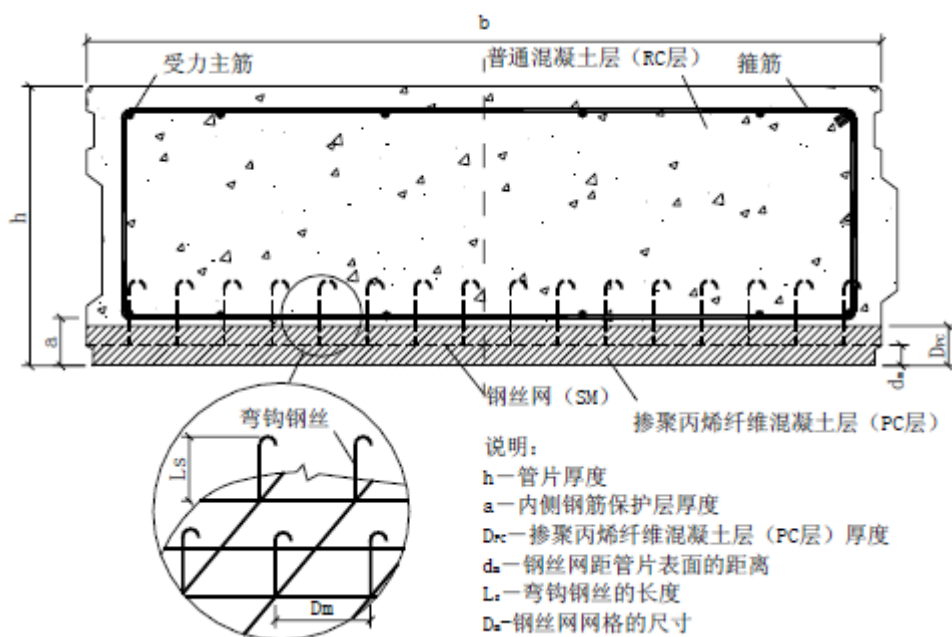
掺聚丙烯纤维混凝土耐火保护层的详细构造
